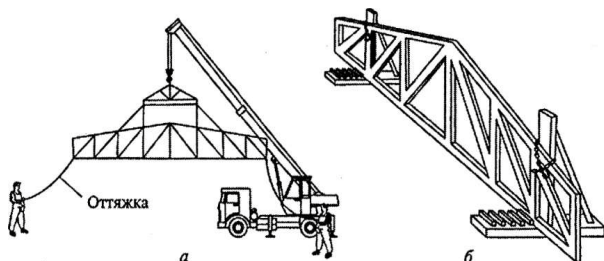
Строповка (а) и складирование ферм на металлических опорах (б)
